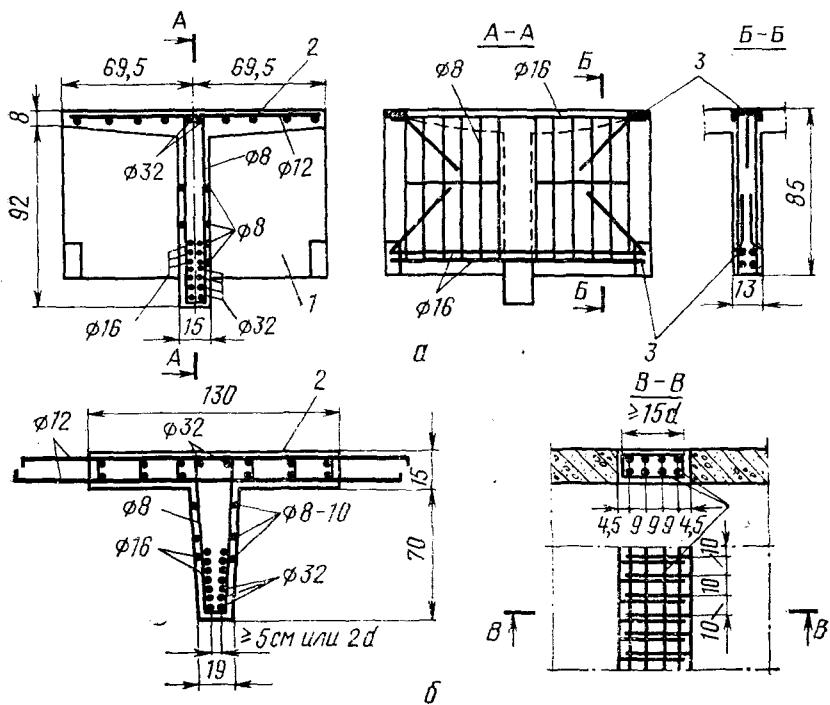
Конструкция сборных ребристых балок с плоскими сварными каркасами:
